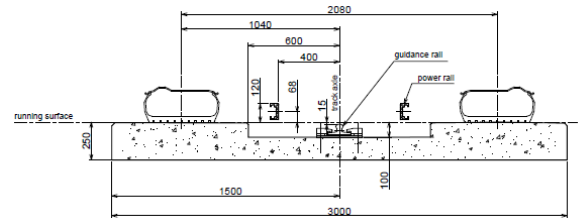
Section générale d'une dalle de voie / Overall section of one slab track
